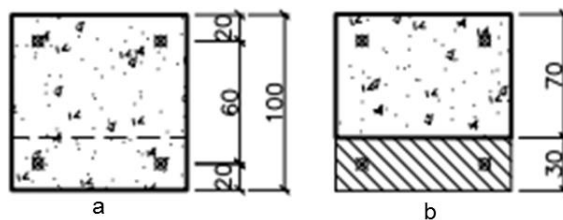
Detalhes da viga: (a) vista lateral; (b) corte A-A' (dimensões em mm).
